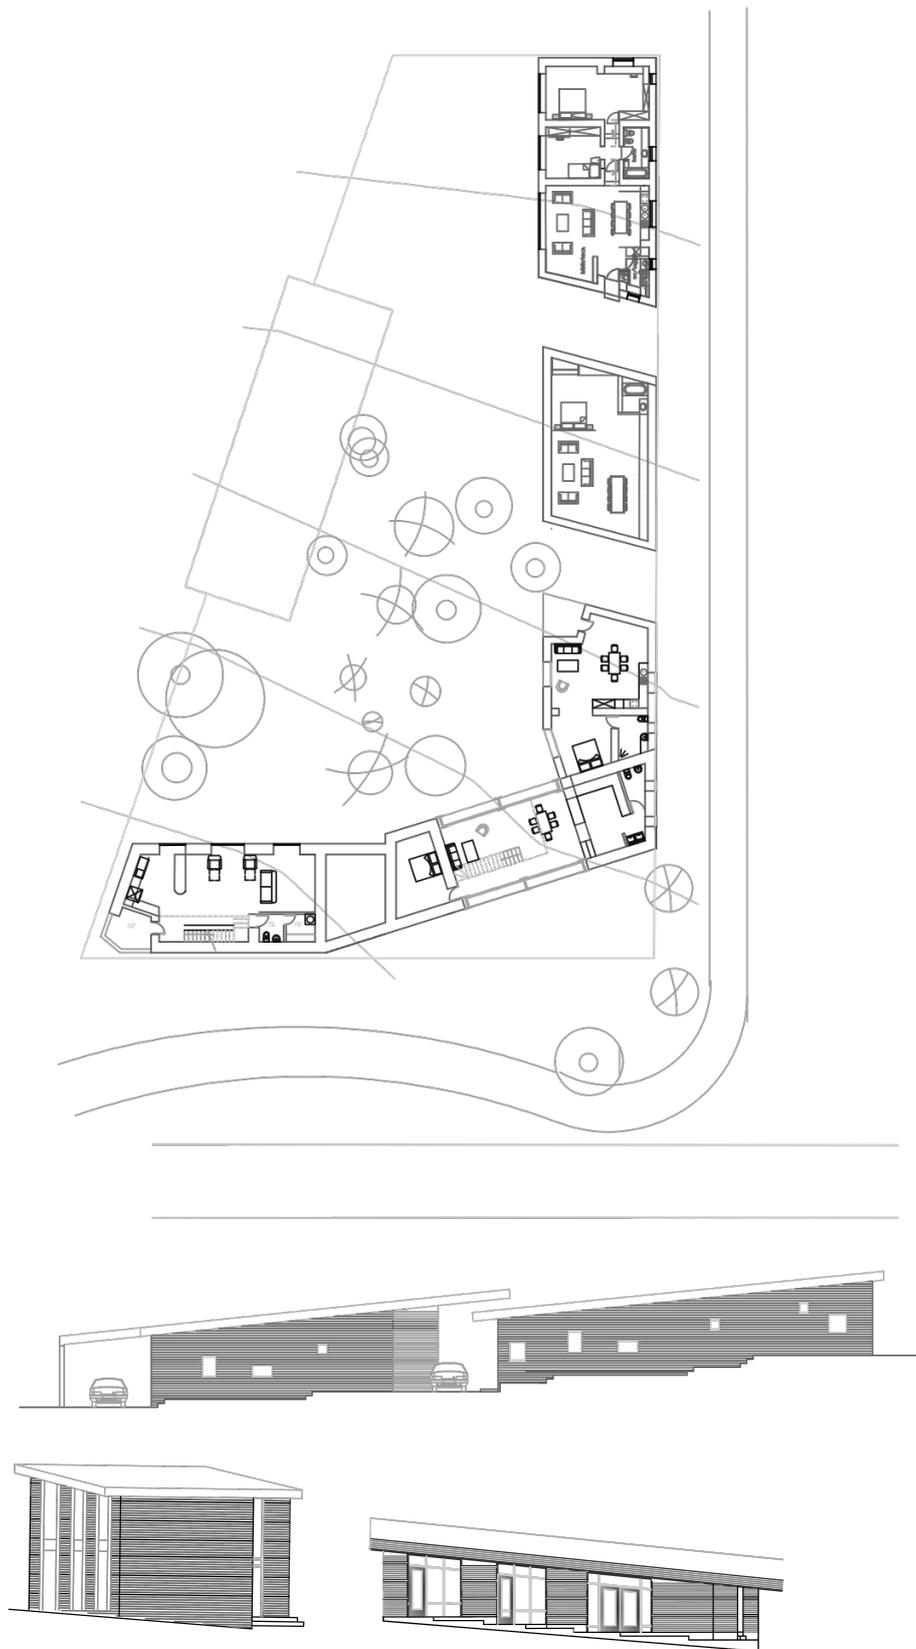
Planimetria de proceso Casa Adobe Armado, 2016. Fuente: Archivo Marcelo Cortés
